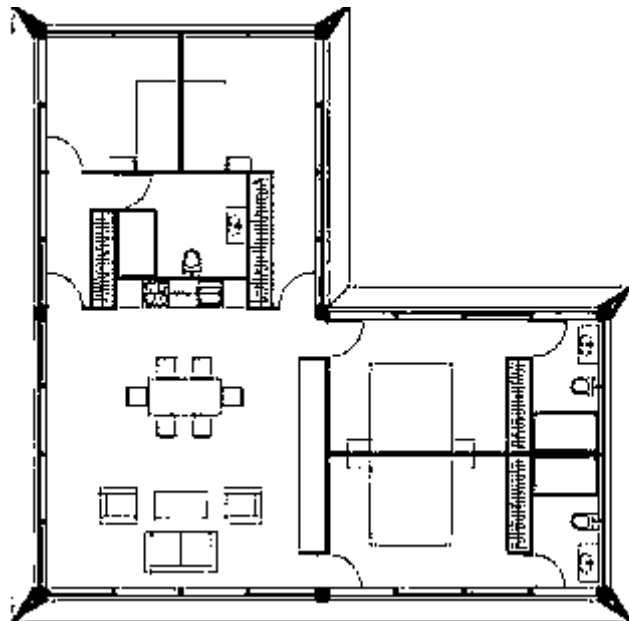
, 77 y 78. Diferentes propuestas de planta de la vivienda. Obtenidas de: <http://www.construyehogar.com/wp-content/uploads/2015/02/Dise%C3%B1o-de-moderna-casa-monovolumen.jpg>
